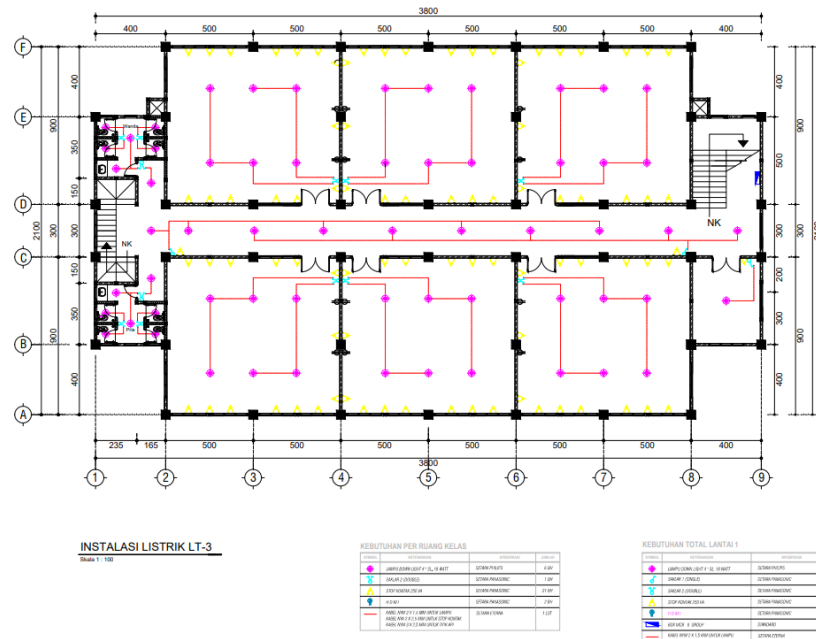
Rencana kerja instalasi listrik lantai 1
